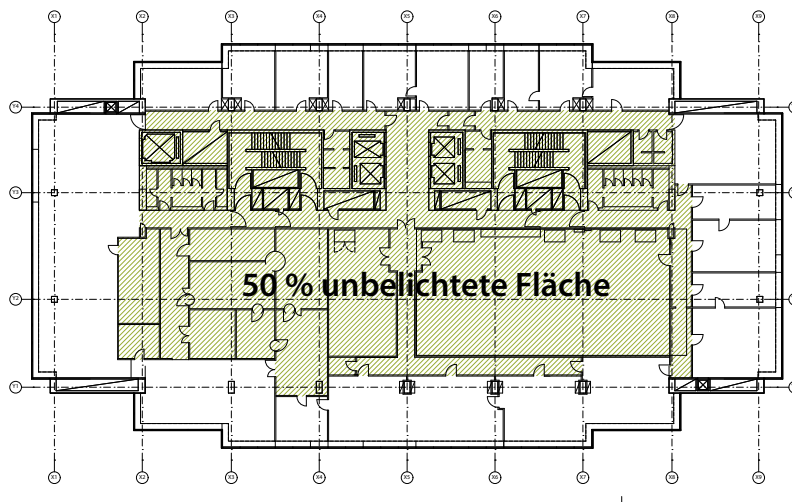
Grundriss 2. Obergeschoss, Rathausstraße 1 / Glaspalast
